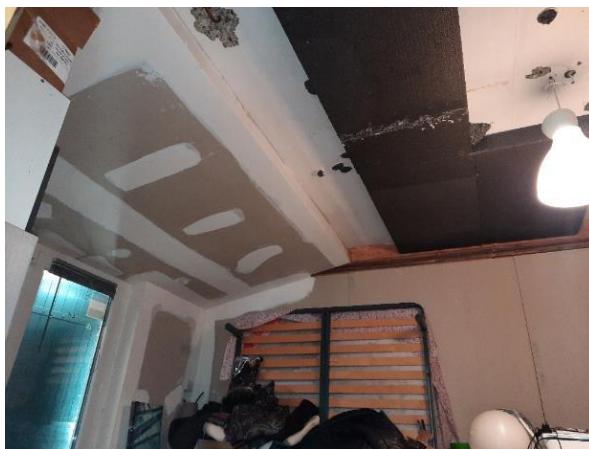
Photo d'une isolation en sous-face de dalle... qui s'avère inutile !
